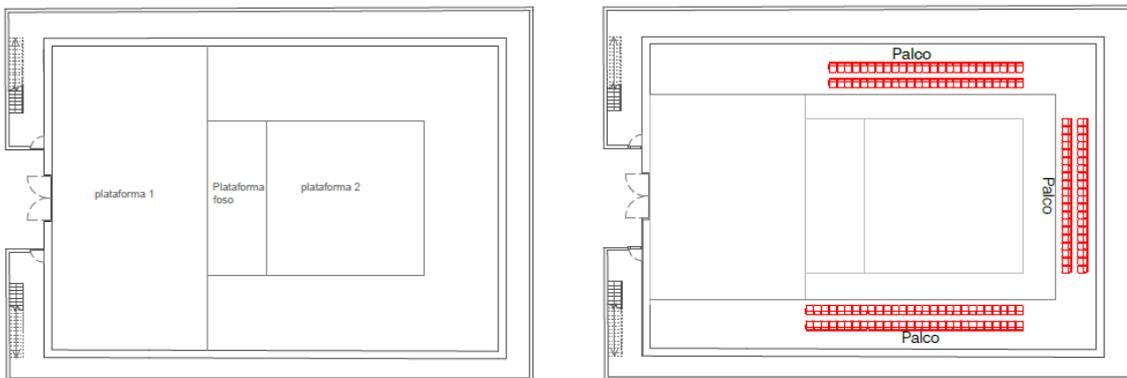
Planos de las plantas baja y alta en configuración Diáfana. Esquema de la autora
